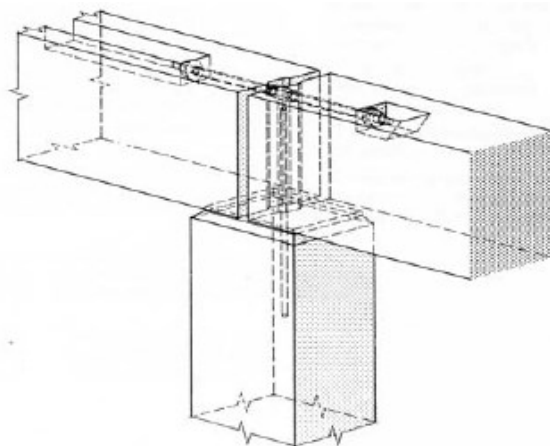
Modelo de ligação entre pilar-viga com recurso a pré-esforço (STUPRÉ, 1981).
